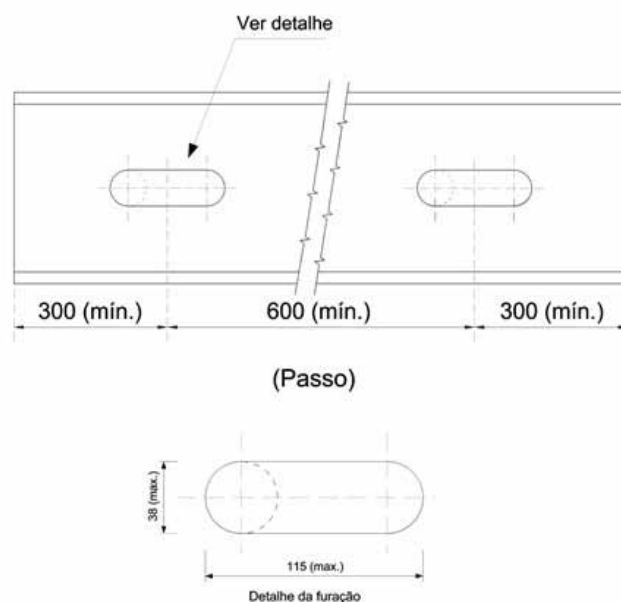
Dimensões da furação de perfis de Light Steel Framing
